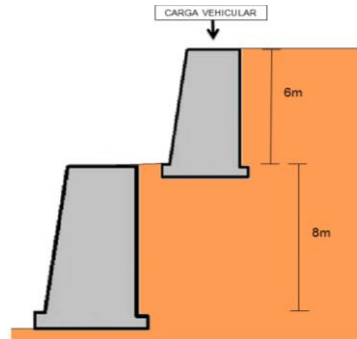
Interpretación SLIDE 5.0, muro completo reforzado
